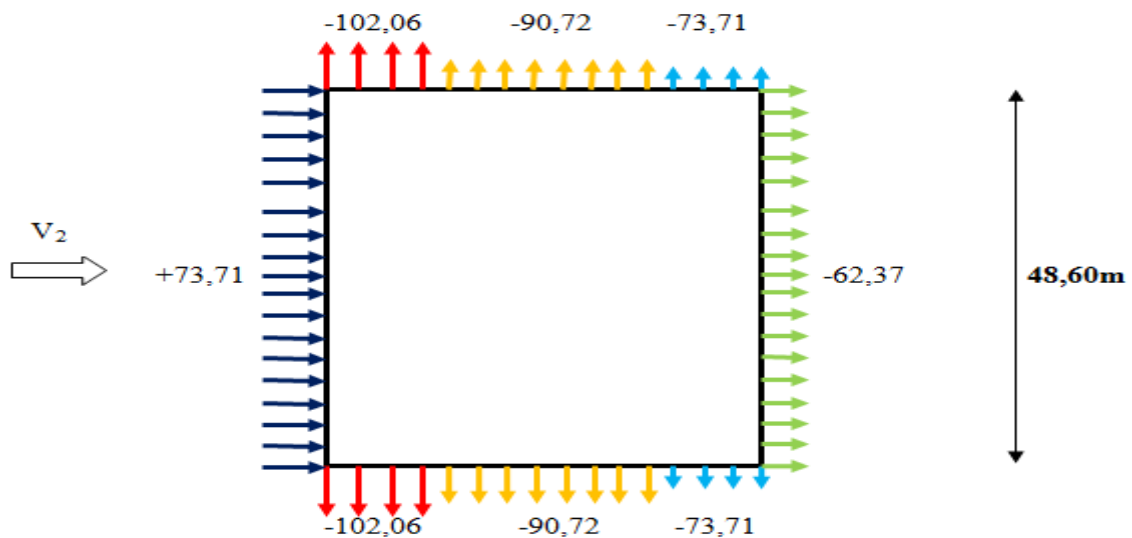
Pressions sur les parois verticales suivant pignon (Niveau 2)
